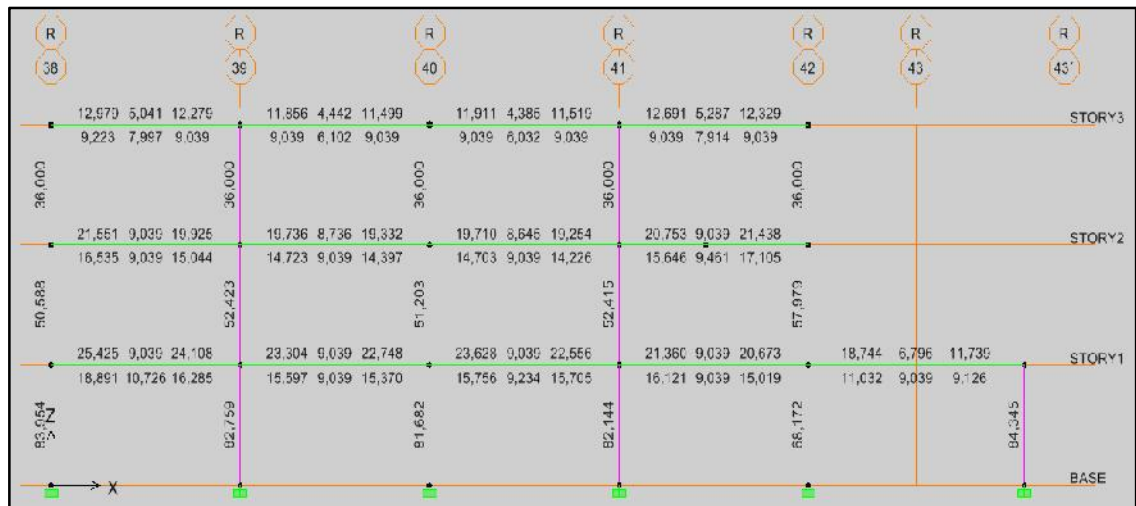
Acero en vigas pórtico R, Consulta Externa I
